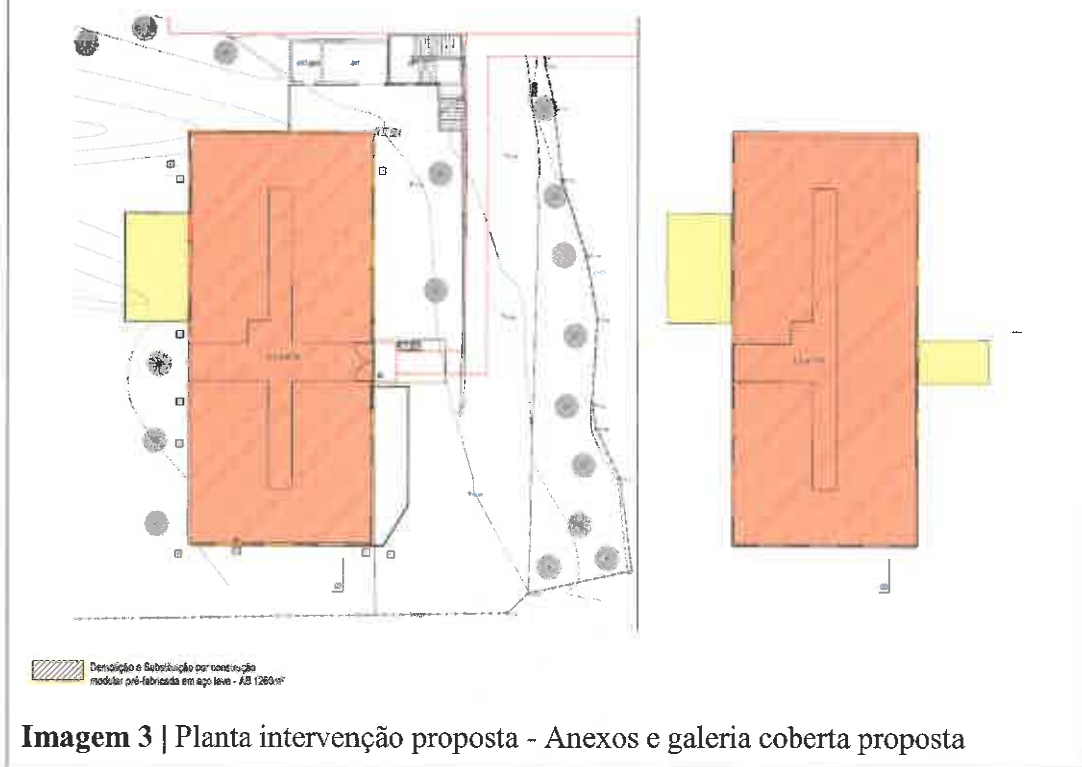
| Planta intervenção proposta - Anexos e galeria coberta proposta
